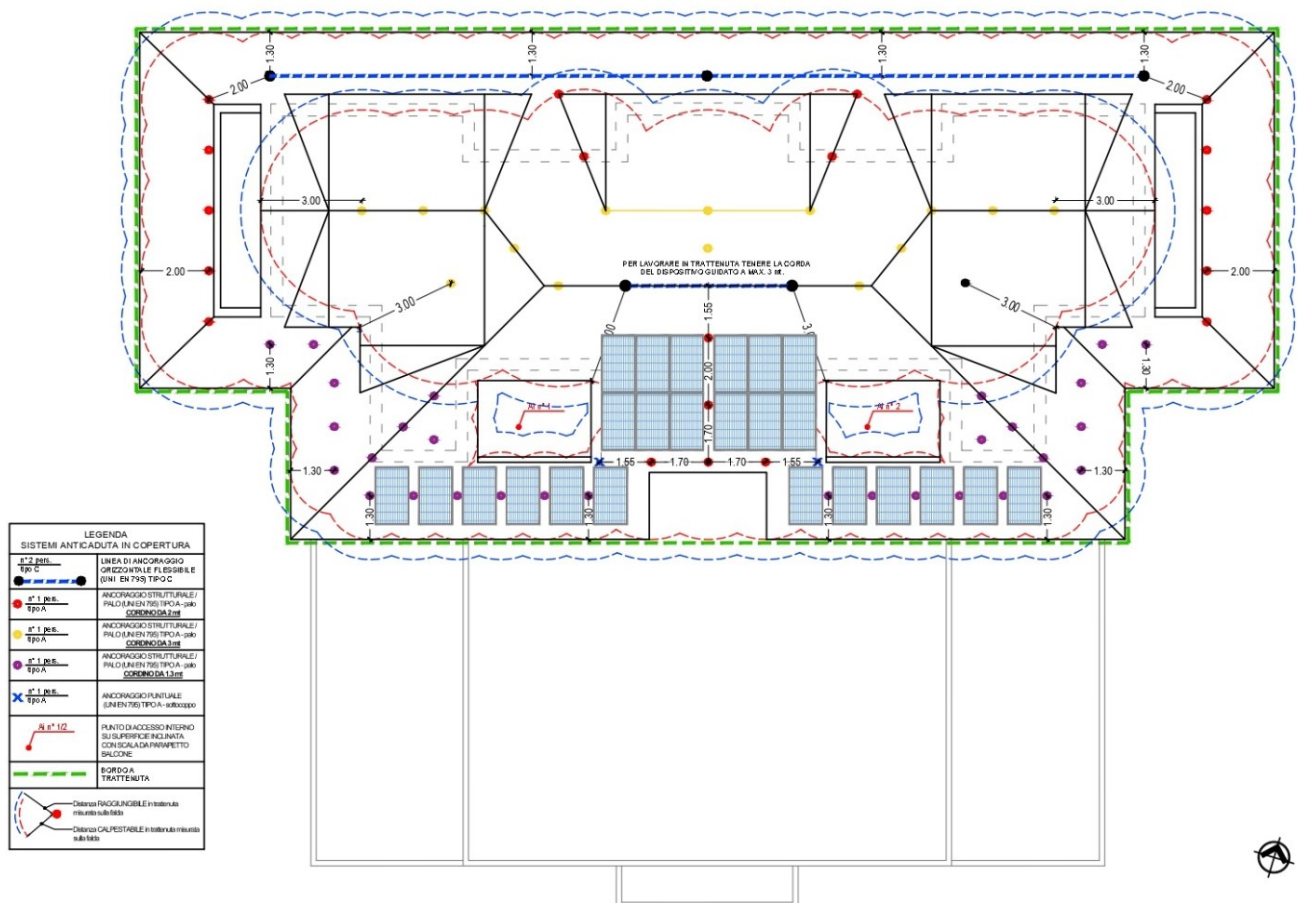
Planimetria copertura con linea vita e ancoraggi
